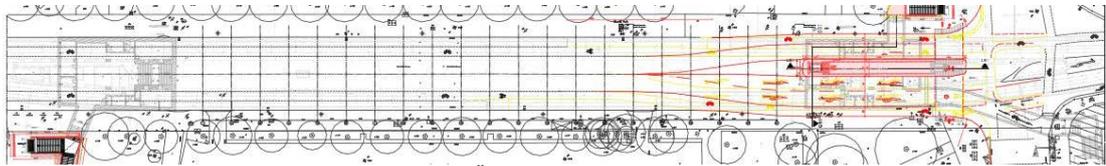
Übersicht Standortvarianten, Variante I, Ausschnitt Plan He_PG001
